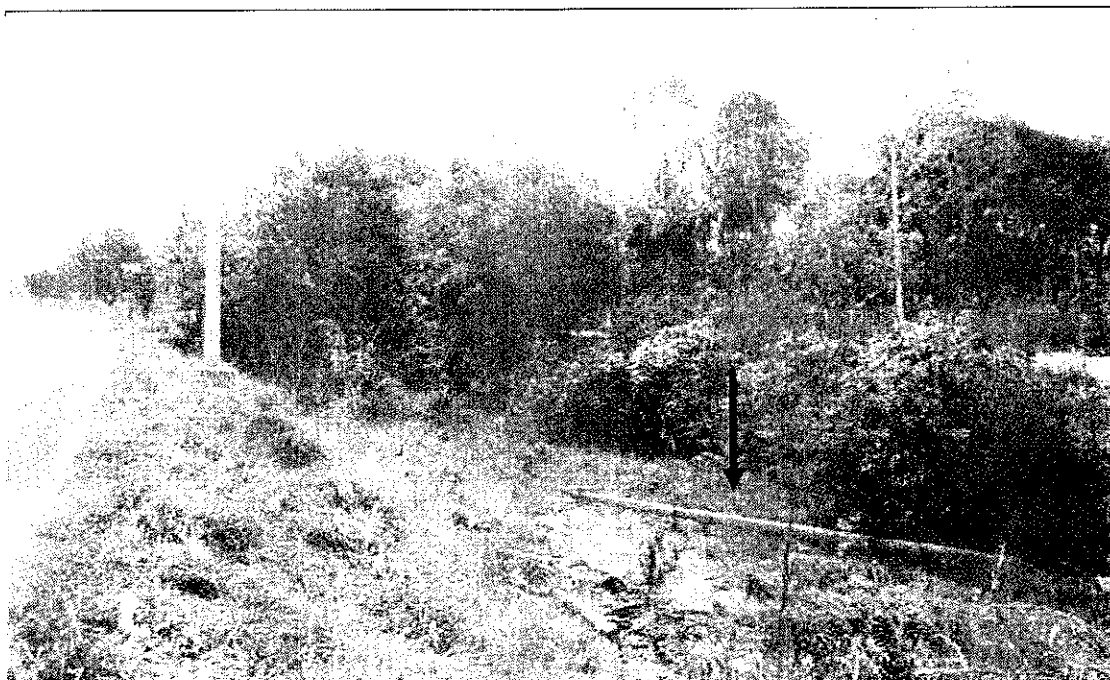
ANTES – Poste de concreto em terra localizado próximo a BR 364 na margem esquerda o rio Jacy.
